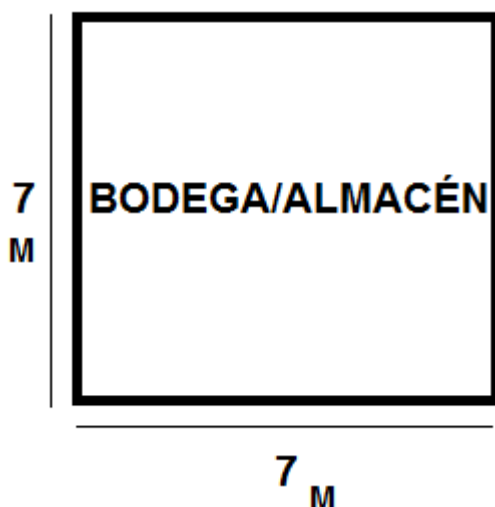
Dimensiones del Almacén/bodega de la planta de tratamiento.
